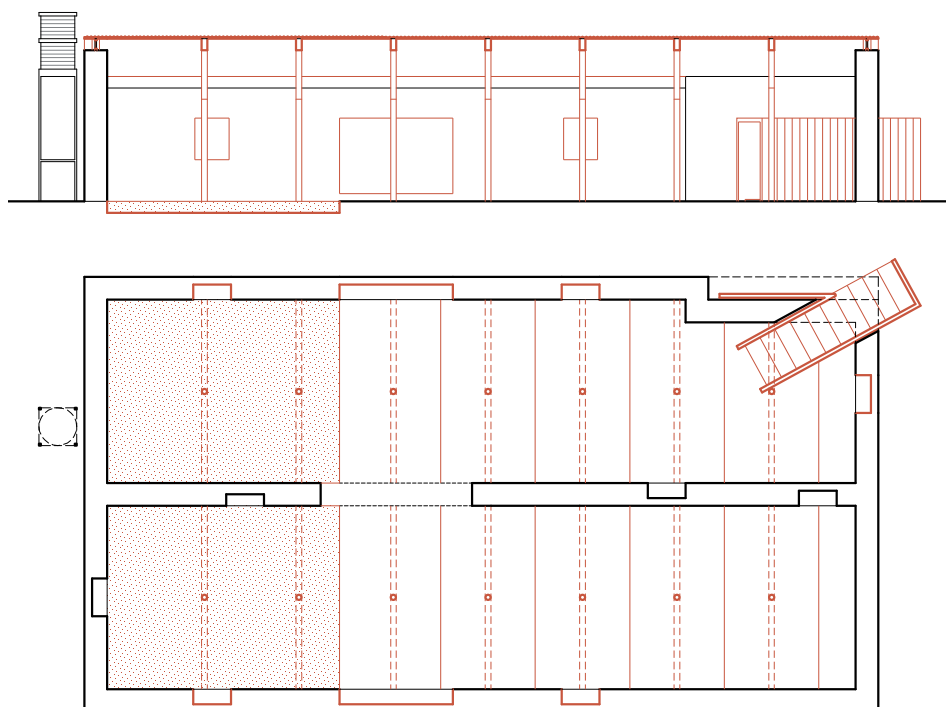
Corte e planta da proposta para a oficina abandonada, escala 1:200
